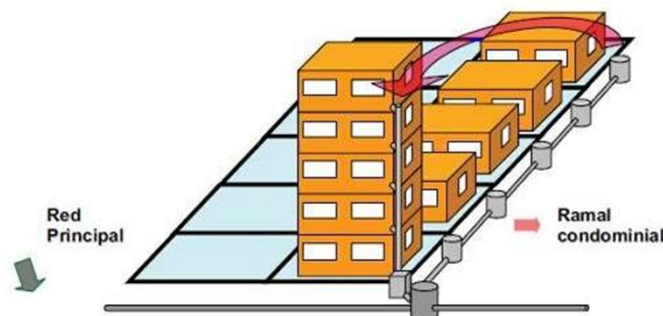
Sistema de alcantarillado condominial. Tomado de Civilgeeks, 2012
